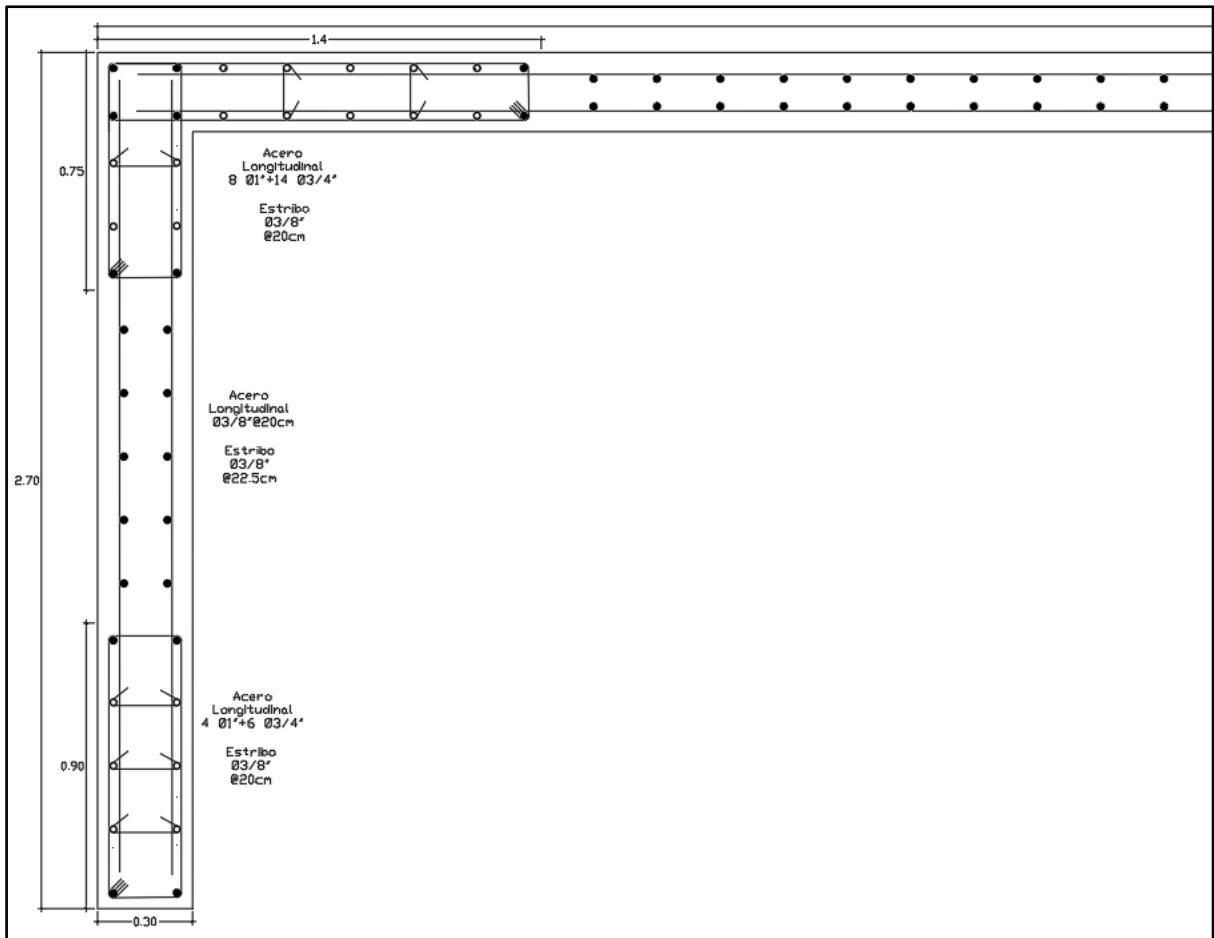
Detalle de hacer para la placa 03 sección transversal (Fuente propia)
